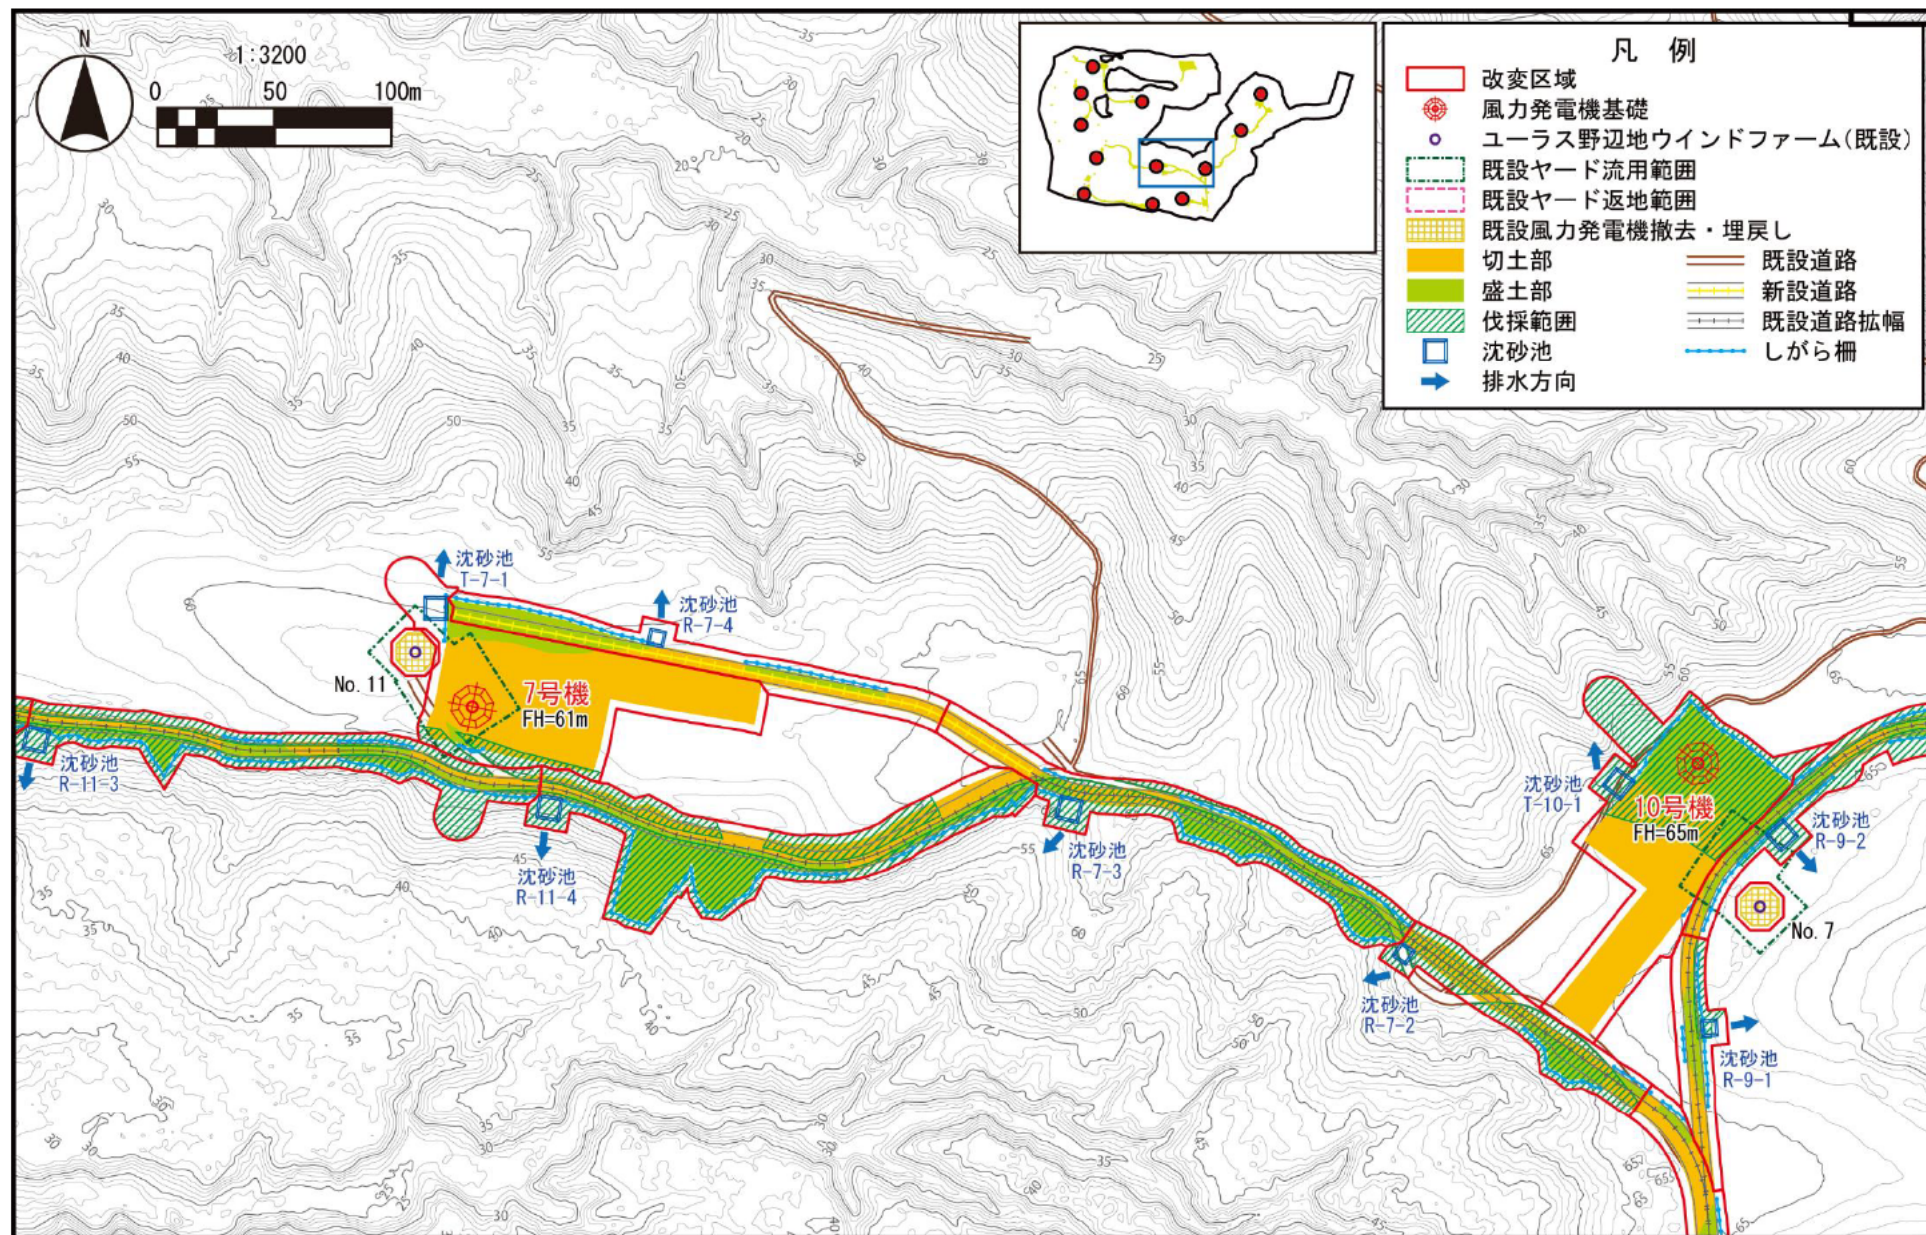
(7) 造成・基礎工事等に伴う改変区域図（平面図）
